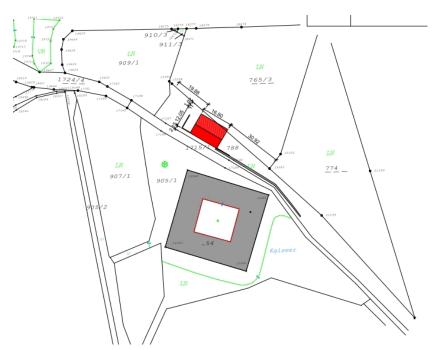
Lageplan bestehender Hof mit geplantem Stallgebäude in Rot, Planungsbüro Schatz KG
